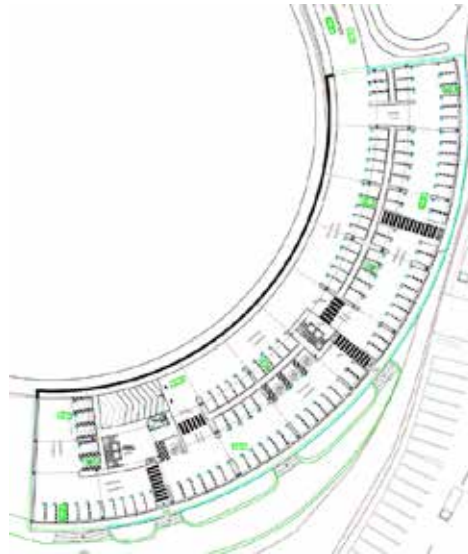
Planta baja del estacionamiento. La Autora (2020)
